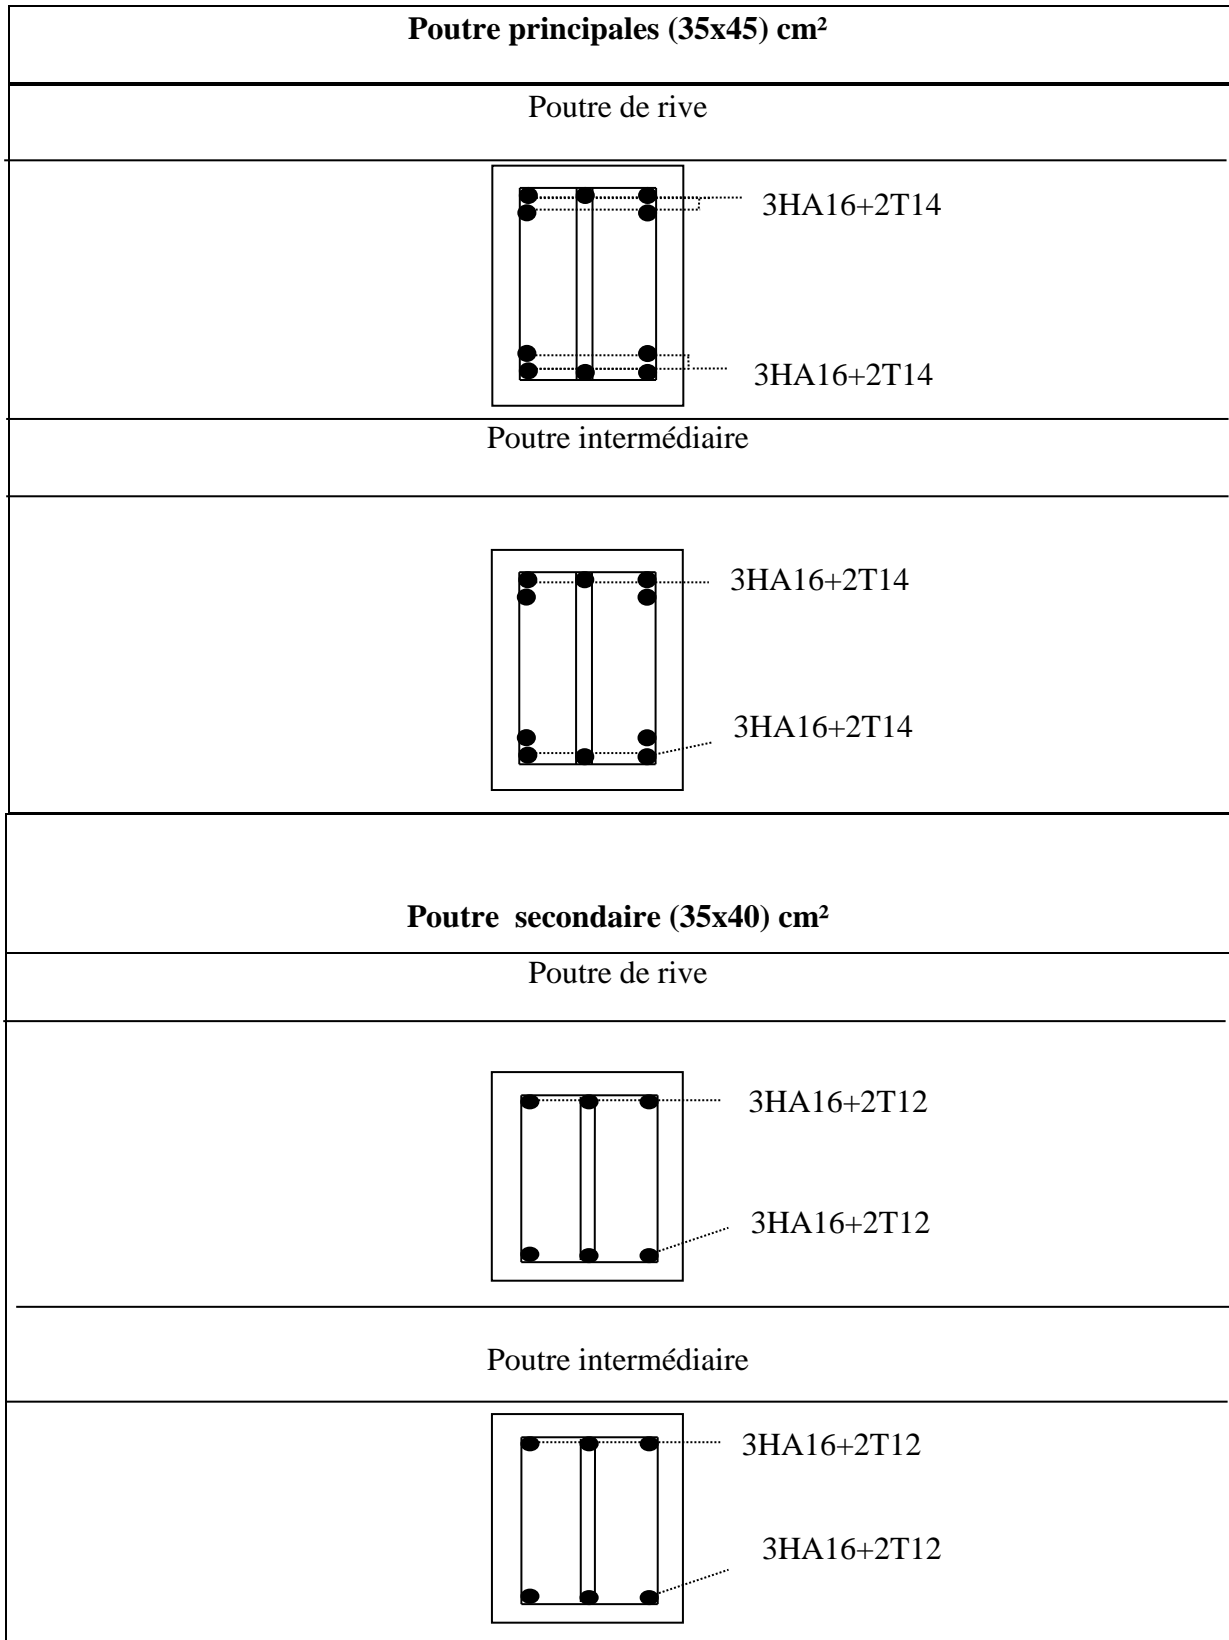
Dessin de ferrailage des sections des poutres principales et secondaires
